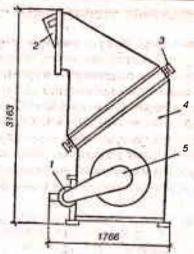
Напольный воздушно-рециркуляционный агрегат СТД-300 М:
